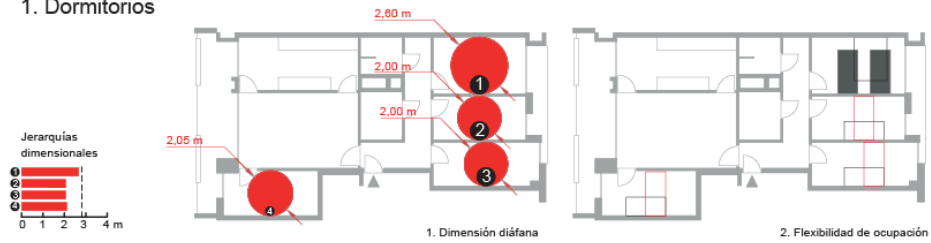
Propuesta de aplicación de recomendaciones a vivienda tipo. Zaida Muxí. (2009).
